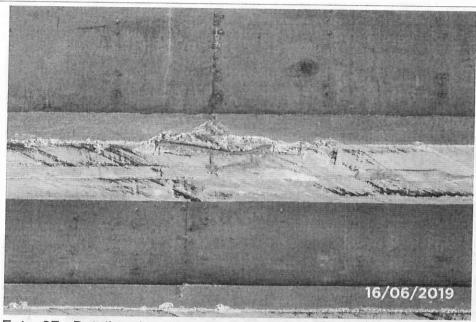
Detalhe das vigas com desplacamento de concreto, e armaduras exposta.
